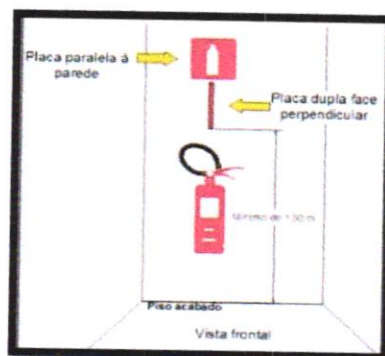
Placa com indicação extintor deve ser colocada a 1,80 do piso do chão.
